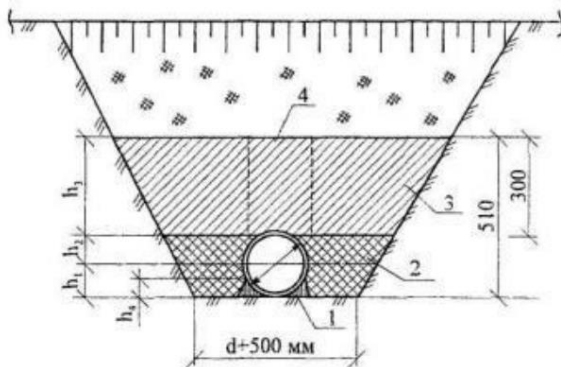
Схема уплотнения грунта вокруг трубопровода при засыпке траншеи:
